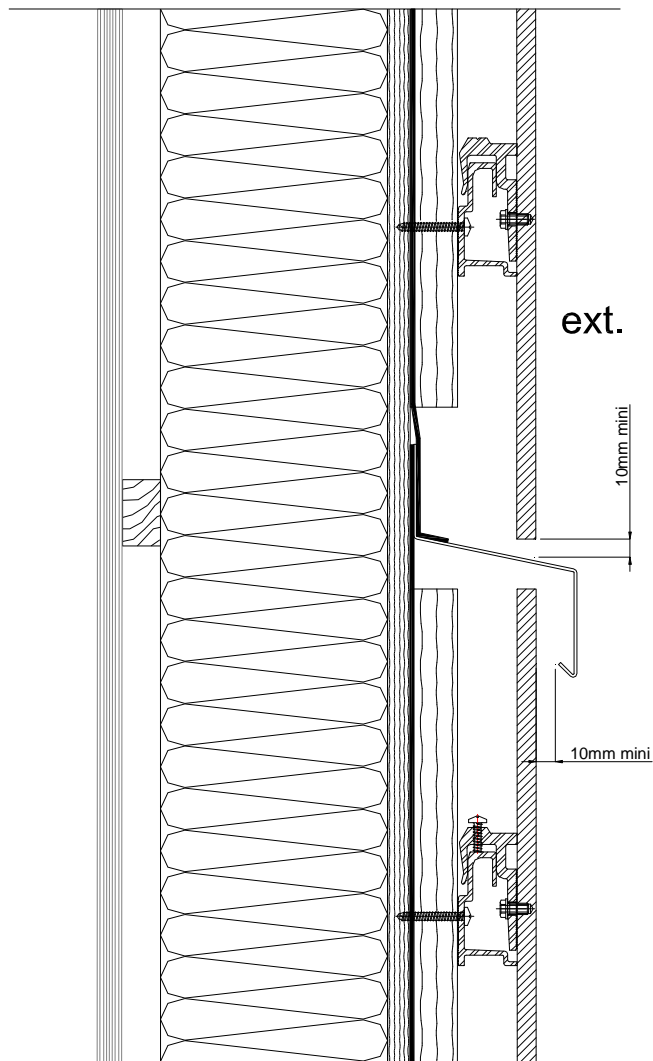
Recouvrement du pare pluie sur MOB tous les 6 m
